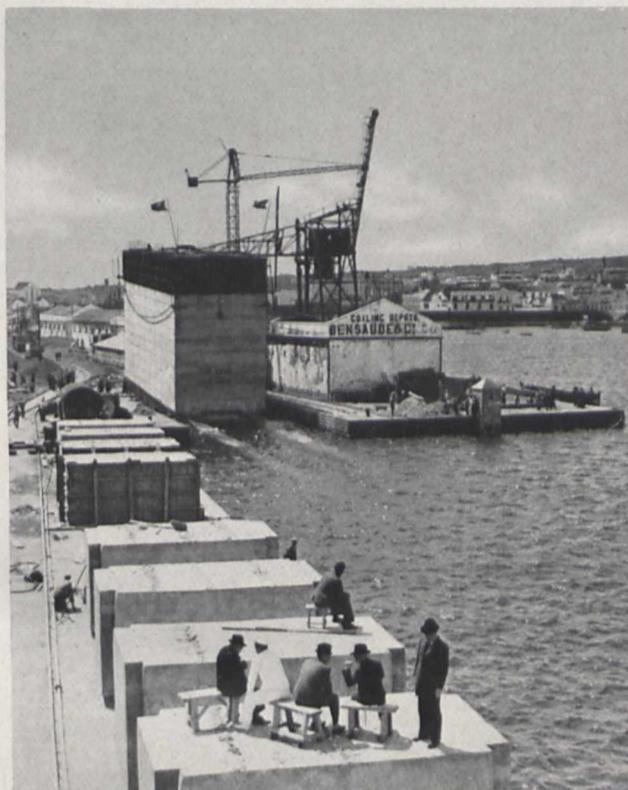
80-t-Betonblöcke auf dem Herstellungsplatz und Eisenbeton-Schwimmkästen kurz vor dem Ablauf von der Helling
